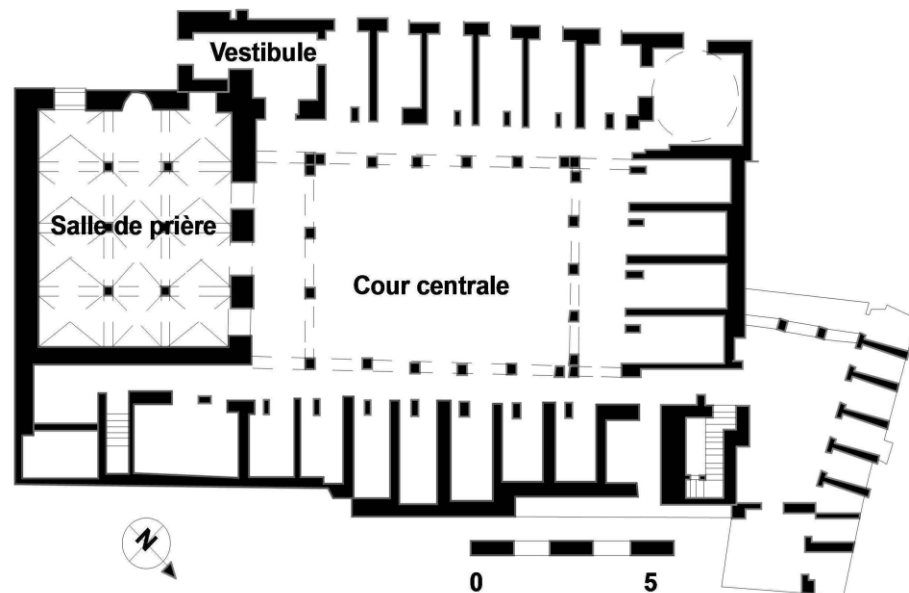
Vue en plan du rez-de-chaussée de la medersa el-Slimāniya
